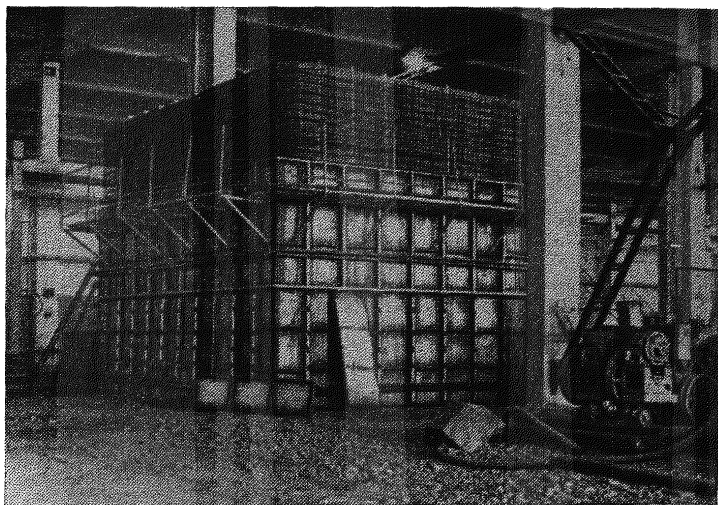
Установка деревометаллической инвентарной опалубки стен резервуара
